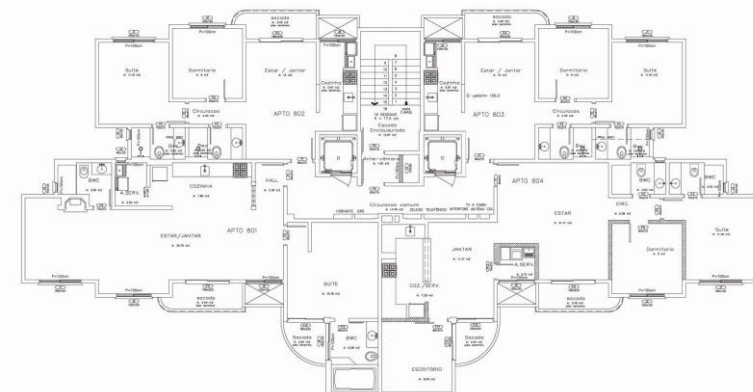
Planta baixa do oitavo pavimento do Edifício Puerto Madero. Fonte: Bolzan (2002)
